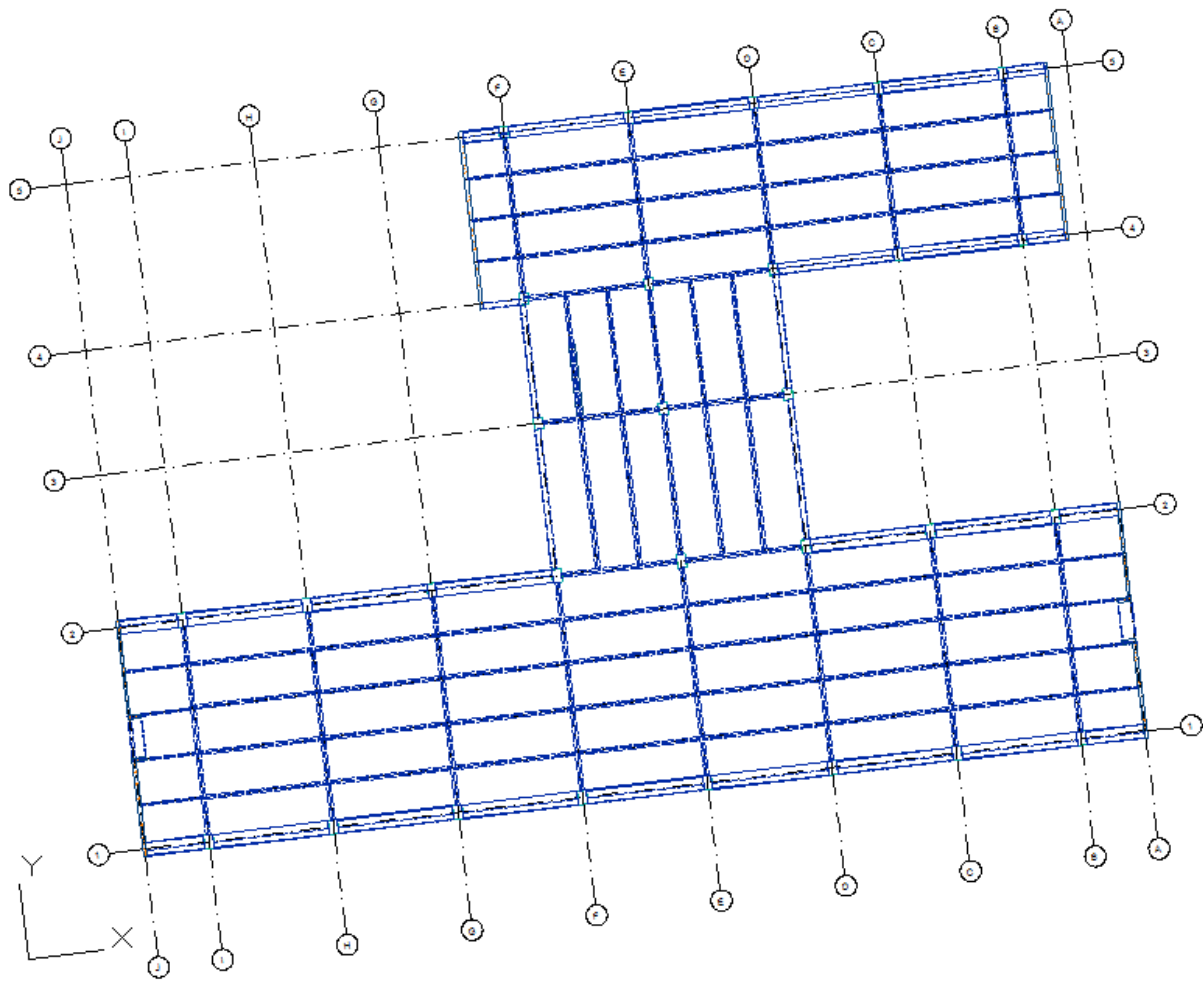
Vista de la Retícula estructural en Planta del Nivel 2.
